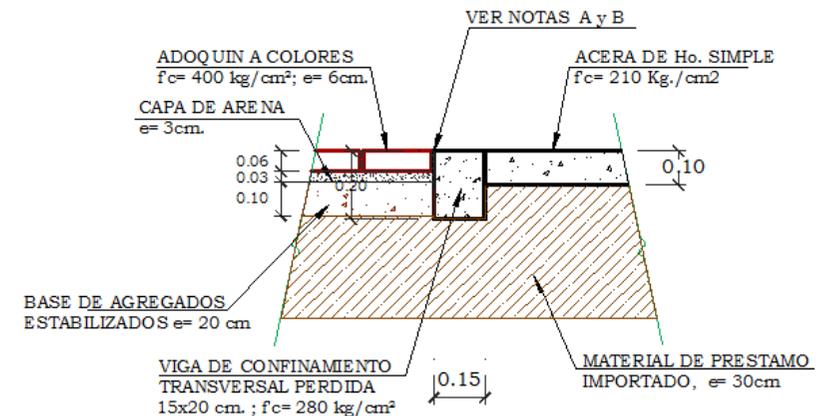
Ejemplo de planos de diseño de área de adoquinamiento (área de análisis) y vigas de confinamiento.
